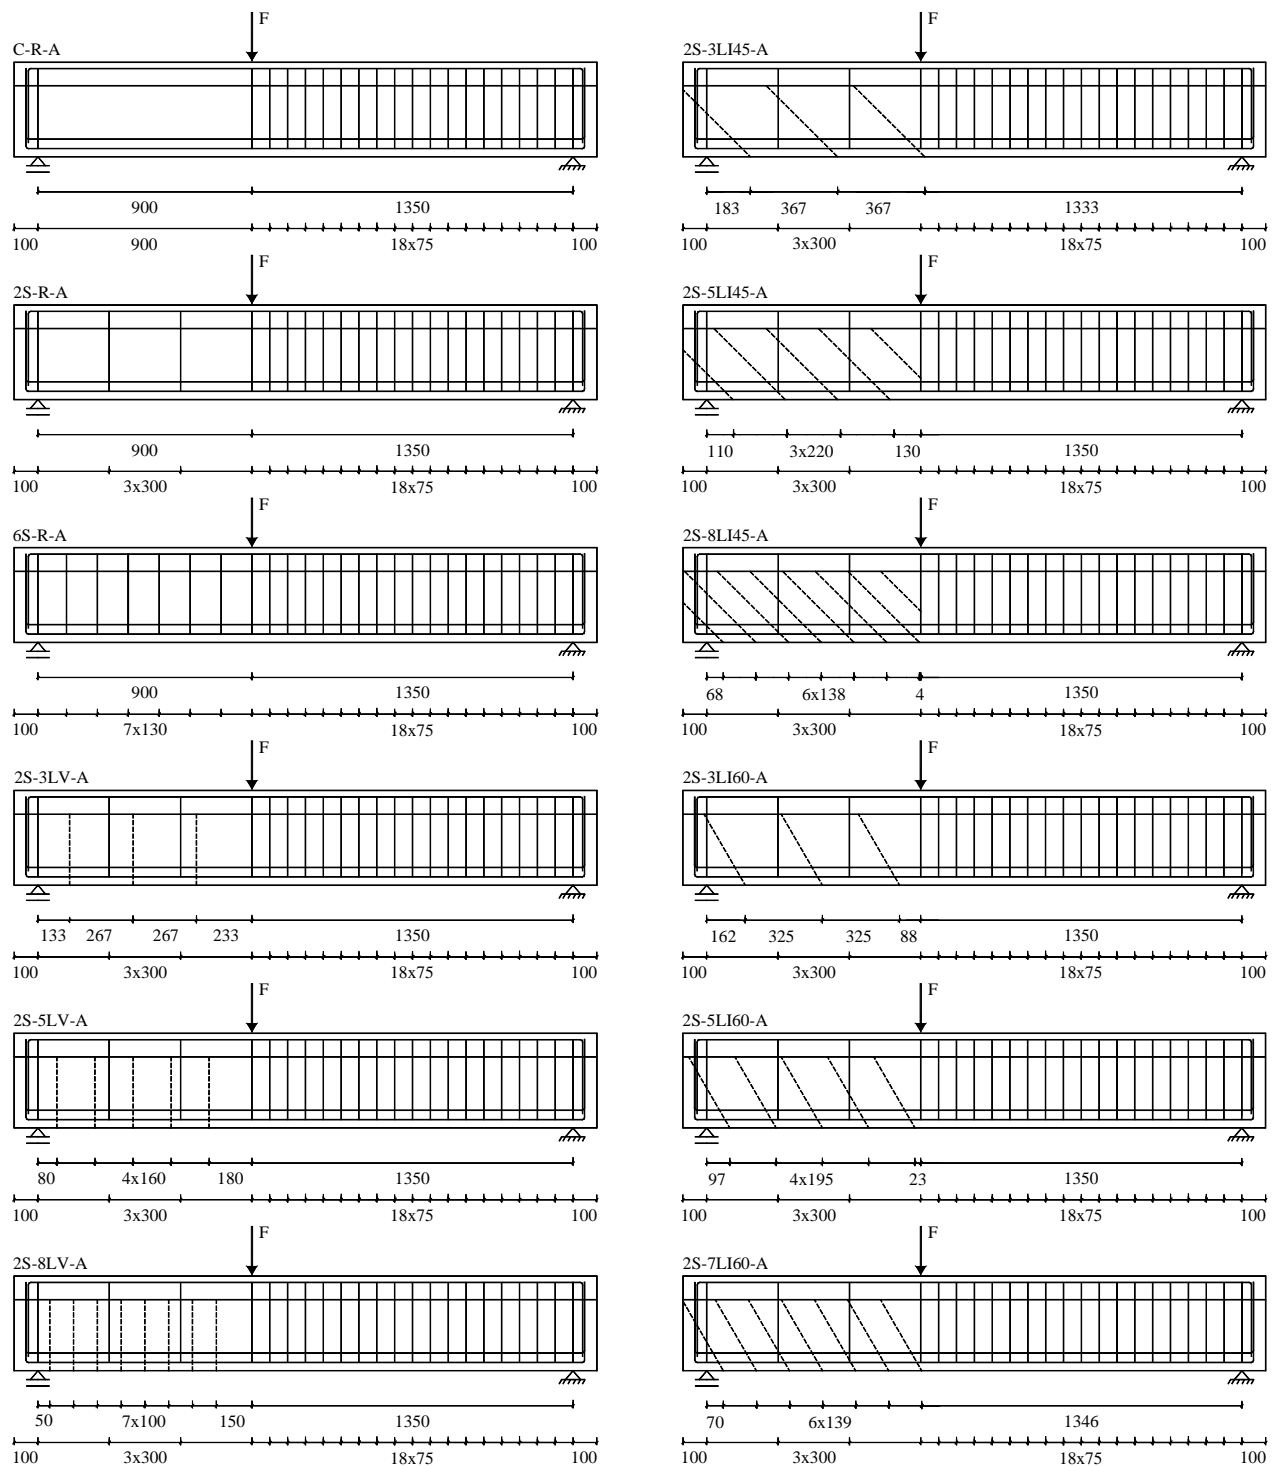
Vigas ensaiadas da série A: localização das armaduras transversais (linha a traço cheio) e dos laminados de CFRP no reforço ao corte (linha a tracejado).
